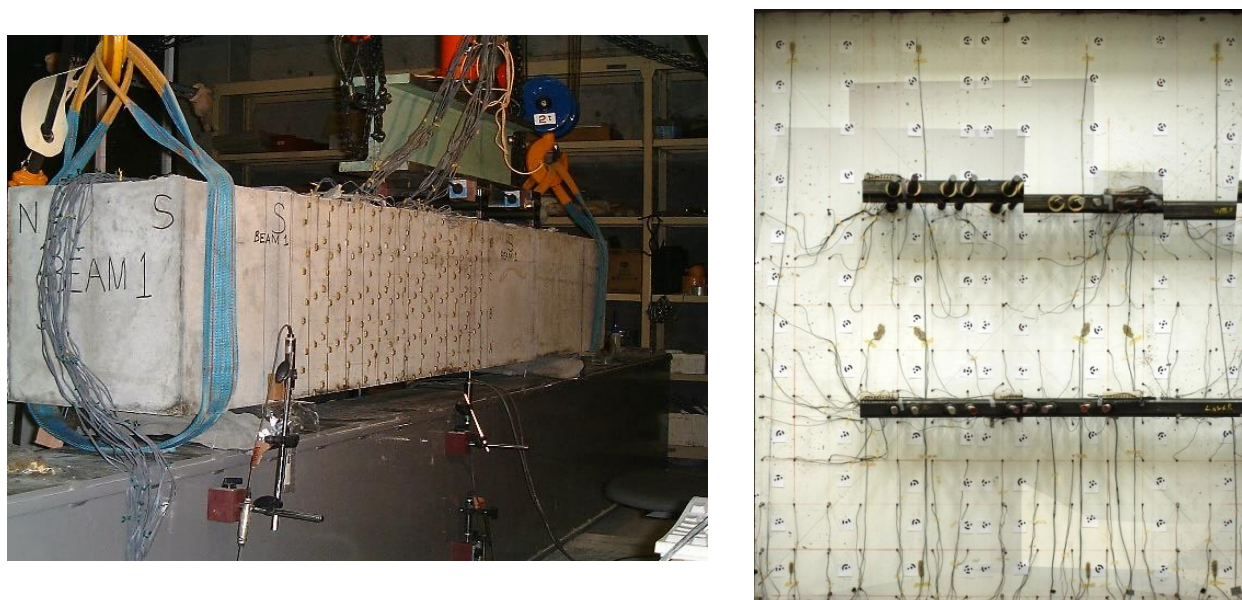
Instrumentación con galgas extensométricas de ensayos a cortante de una viga y un muro de hormigón (Piyamahant, 2002, y Van Haukelem, 2010).
